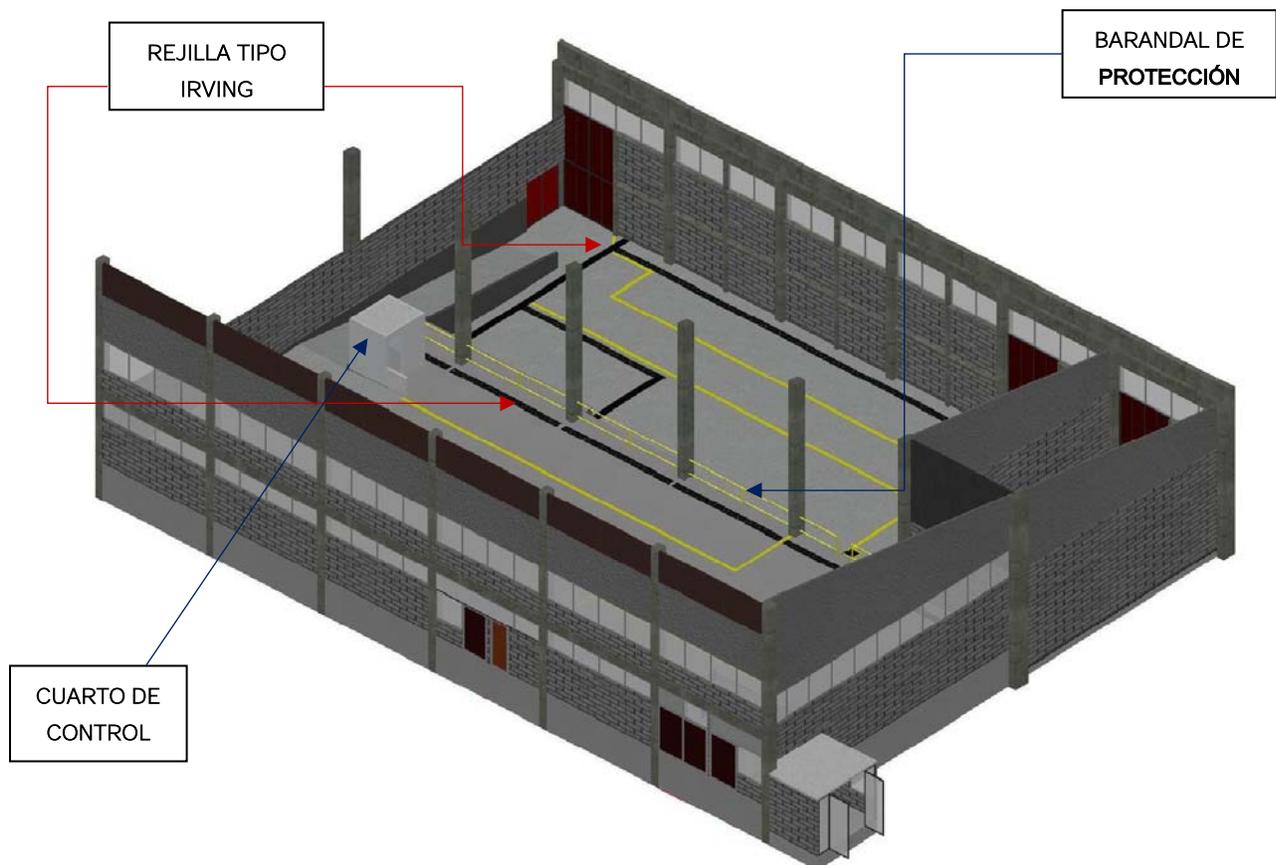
Modelo 3D-Barandales y rejillas en Planta Piloto.
